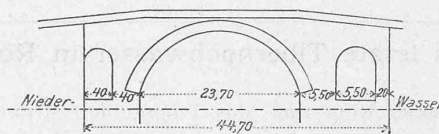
Ponte Cestio. — Alt. 1:1000.
